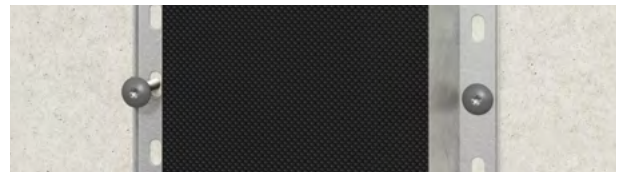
Swisspearl Montageprofil på vandret underkonstruksjon
